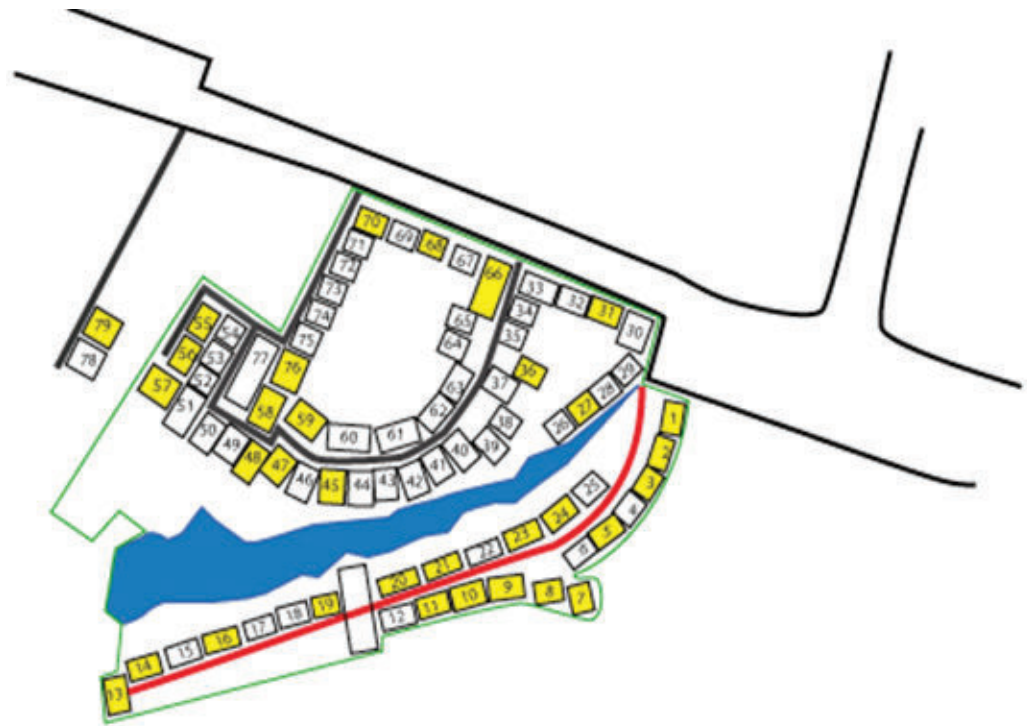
Planta Esquemática Precario El Relleno. Fuente: Estudio de Precarios en la GAM del MIVAH
